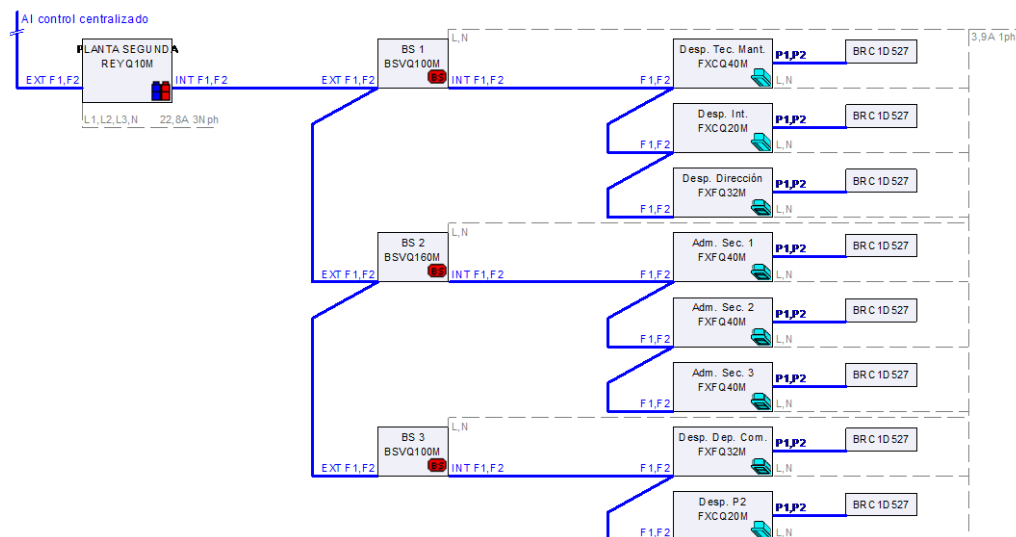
Esquema conexión eléctrica VRV. PLANTA SEGUNDA
